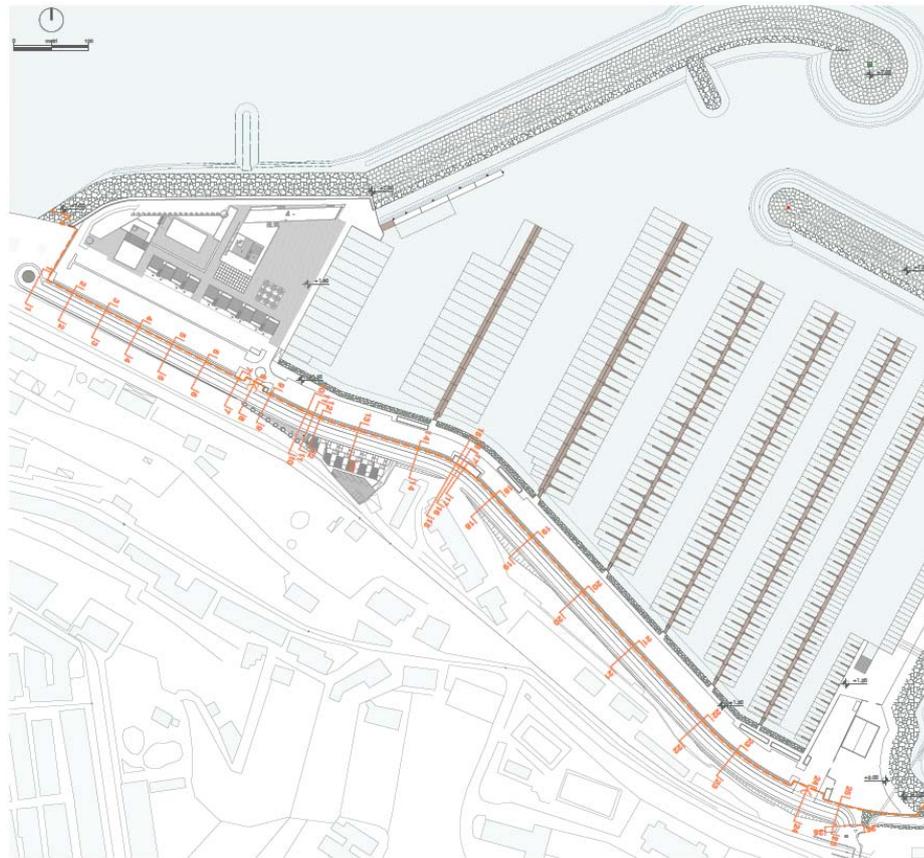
Viabilità portuale di progetto – stralcio planimetrico
